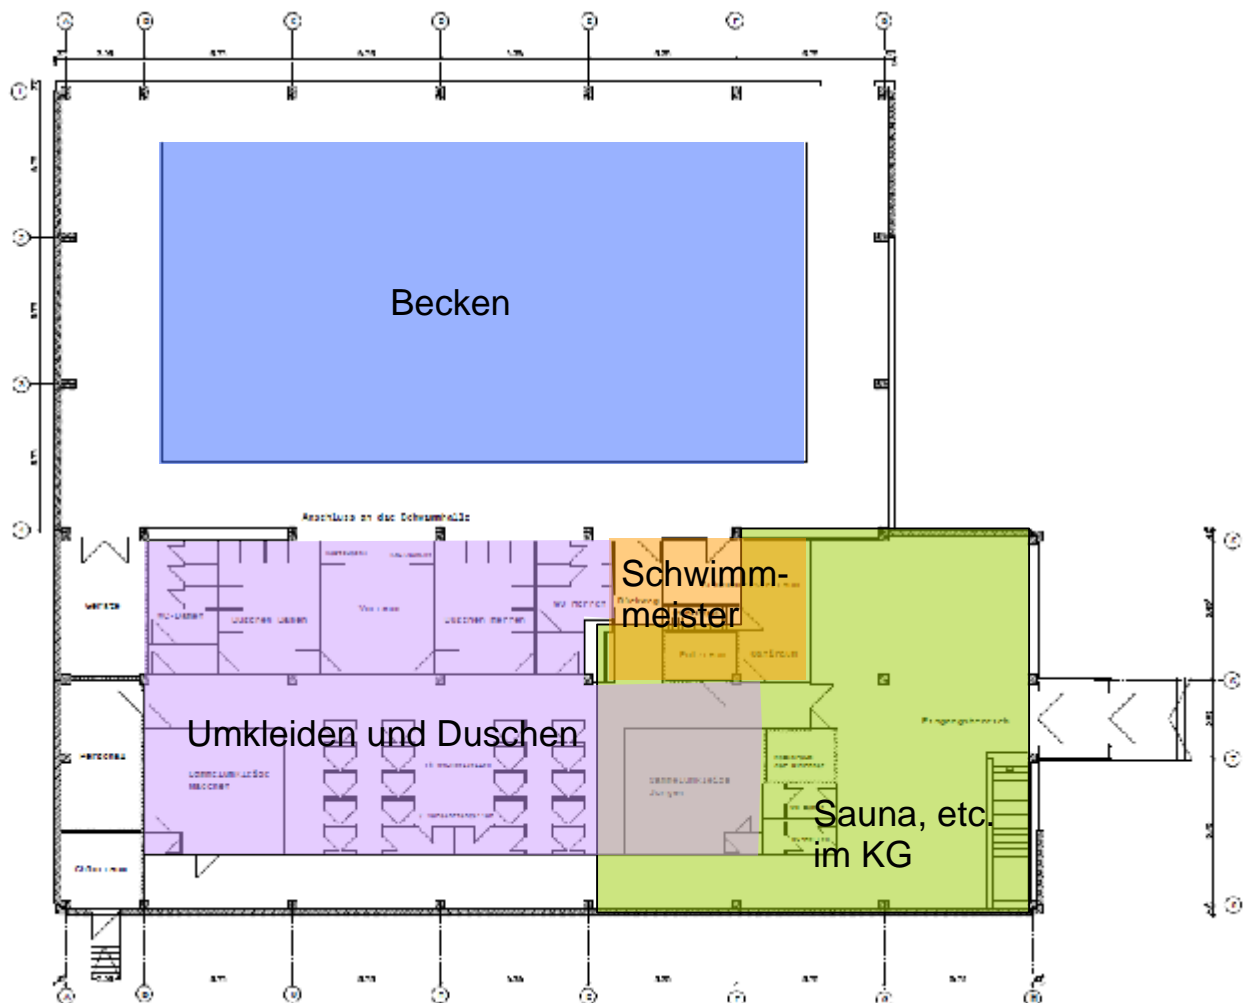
Grundrisschema zur Nomenklatur der Gebäudenutzungsflächen
